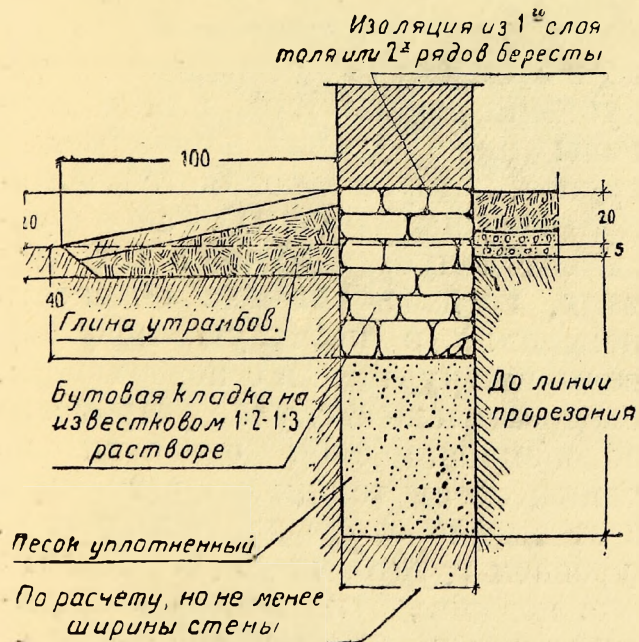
Сплошной фундамент в пучащихся или слабых грунтах.
